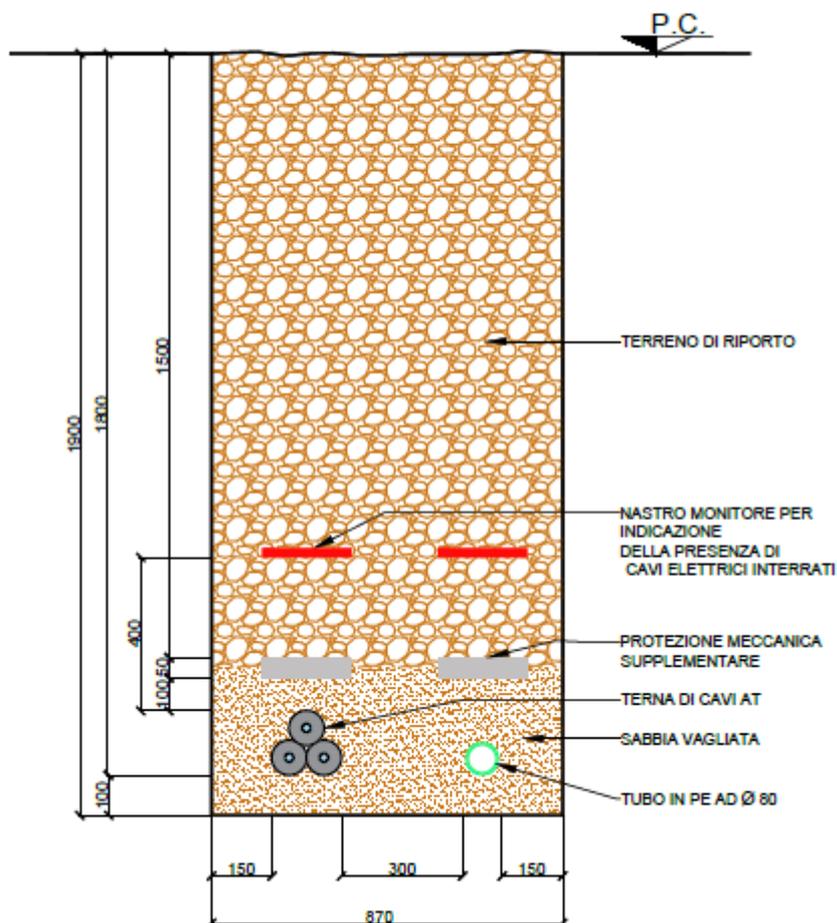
Sezione tipologica scavo e posa cavo AT
